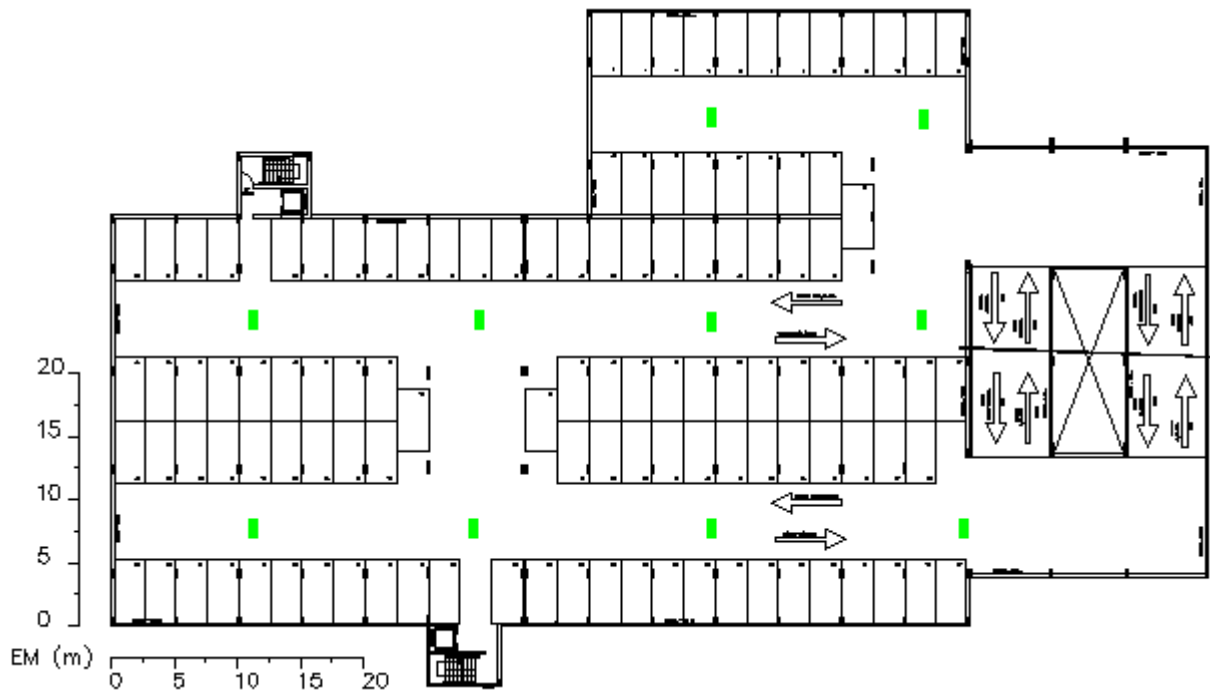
Localização da Sinalização das Saídas no Pavimento Tipo (2° ao 6°)
